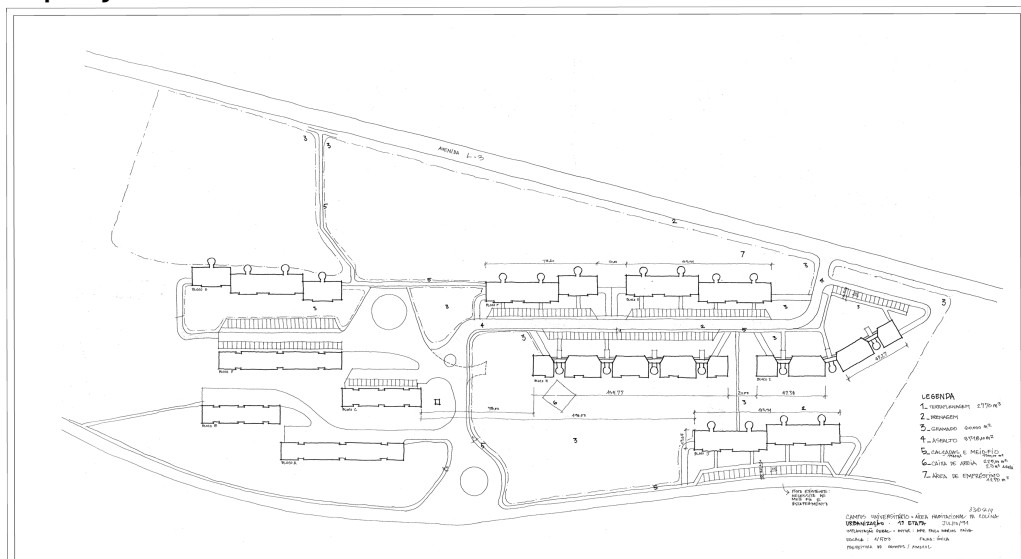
Planta Geral do que foi definido para ser construído em 1987
